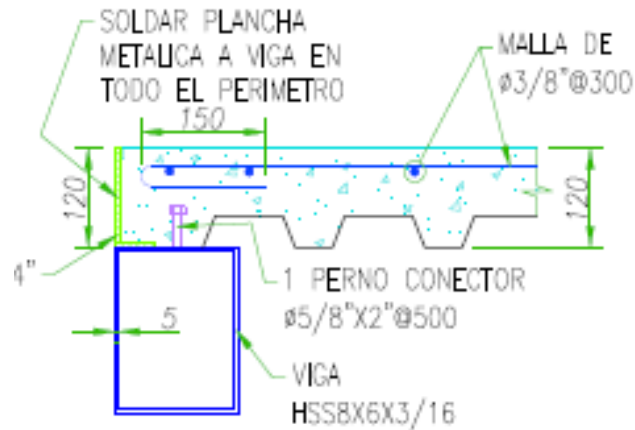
Detalle de sección losa colaborante. Recuperado de proyecto vivienda unifamiliar.
